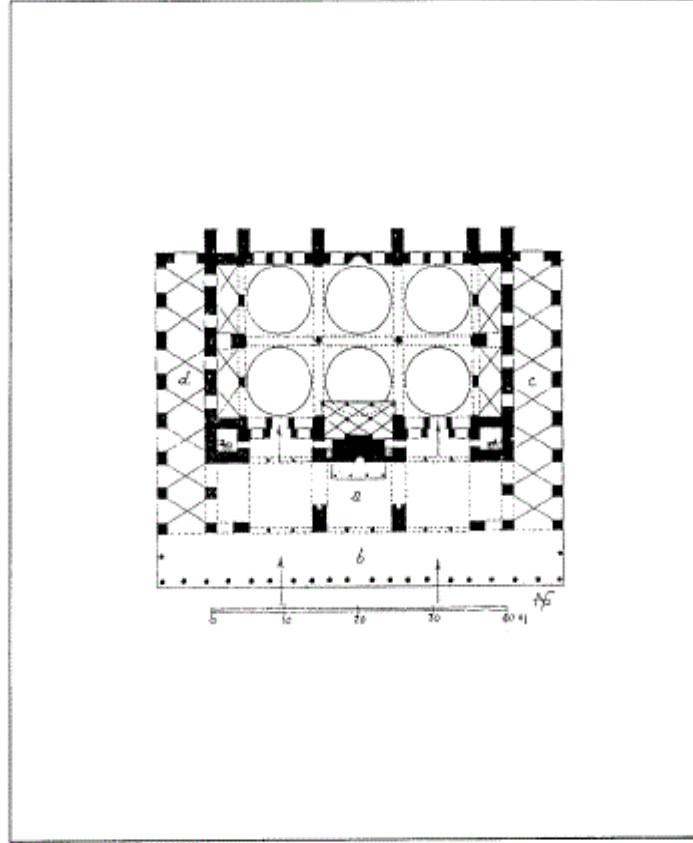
مكرر) مسقط أفقي للمسجد العتيق أو القديم (اسكى جامع) في أدرنة (عن :
